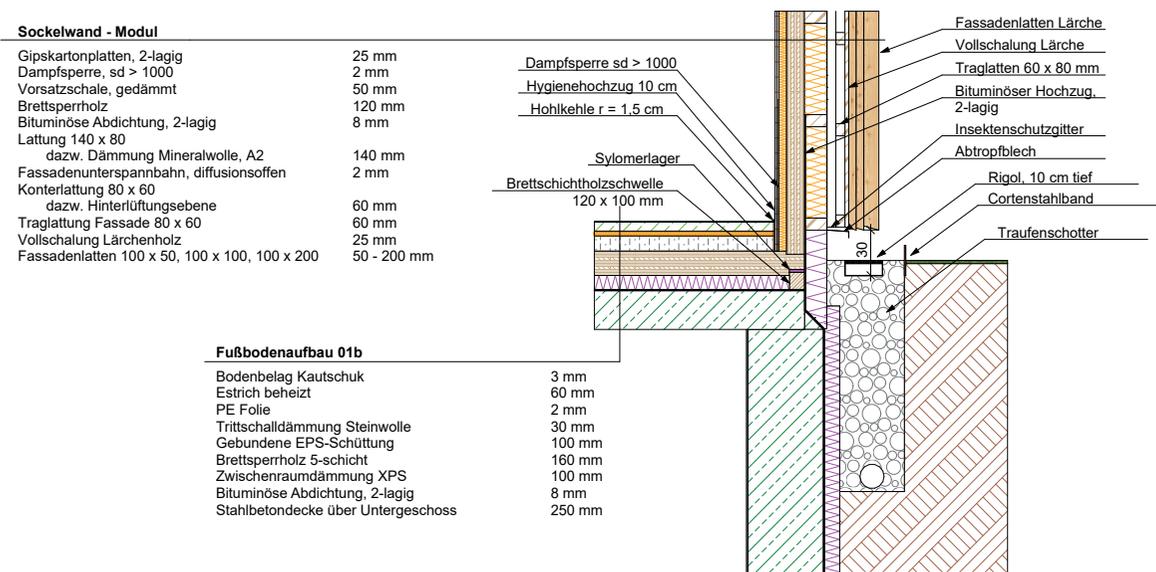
Detail Sockelwand mit Modul im Erdgeschoss
